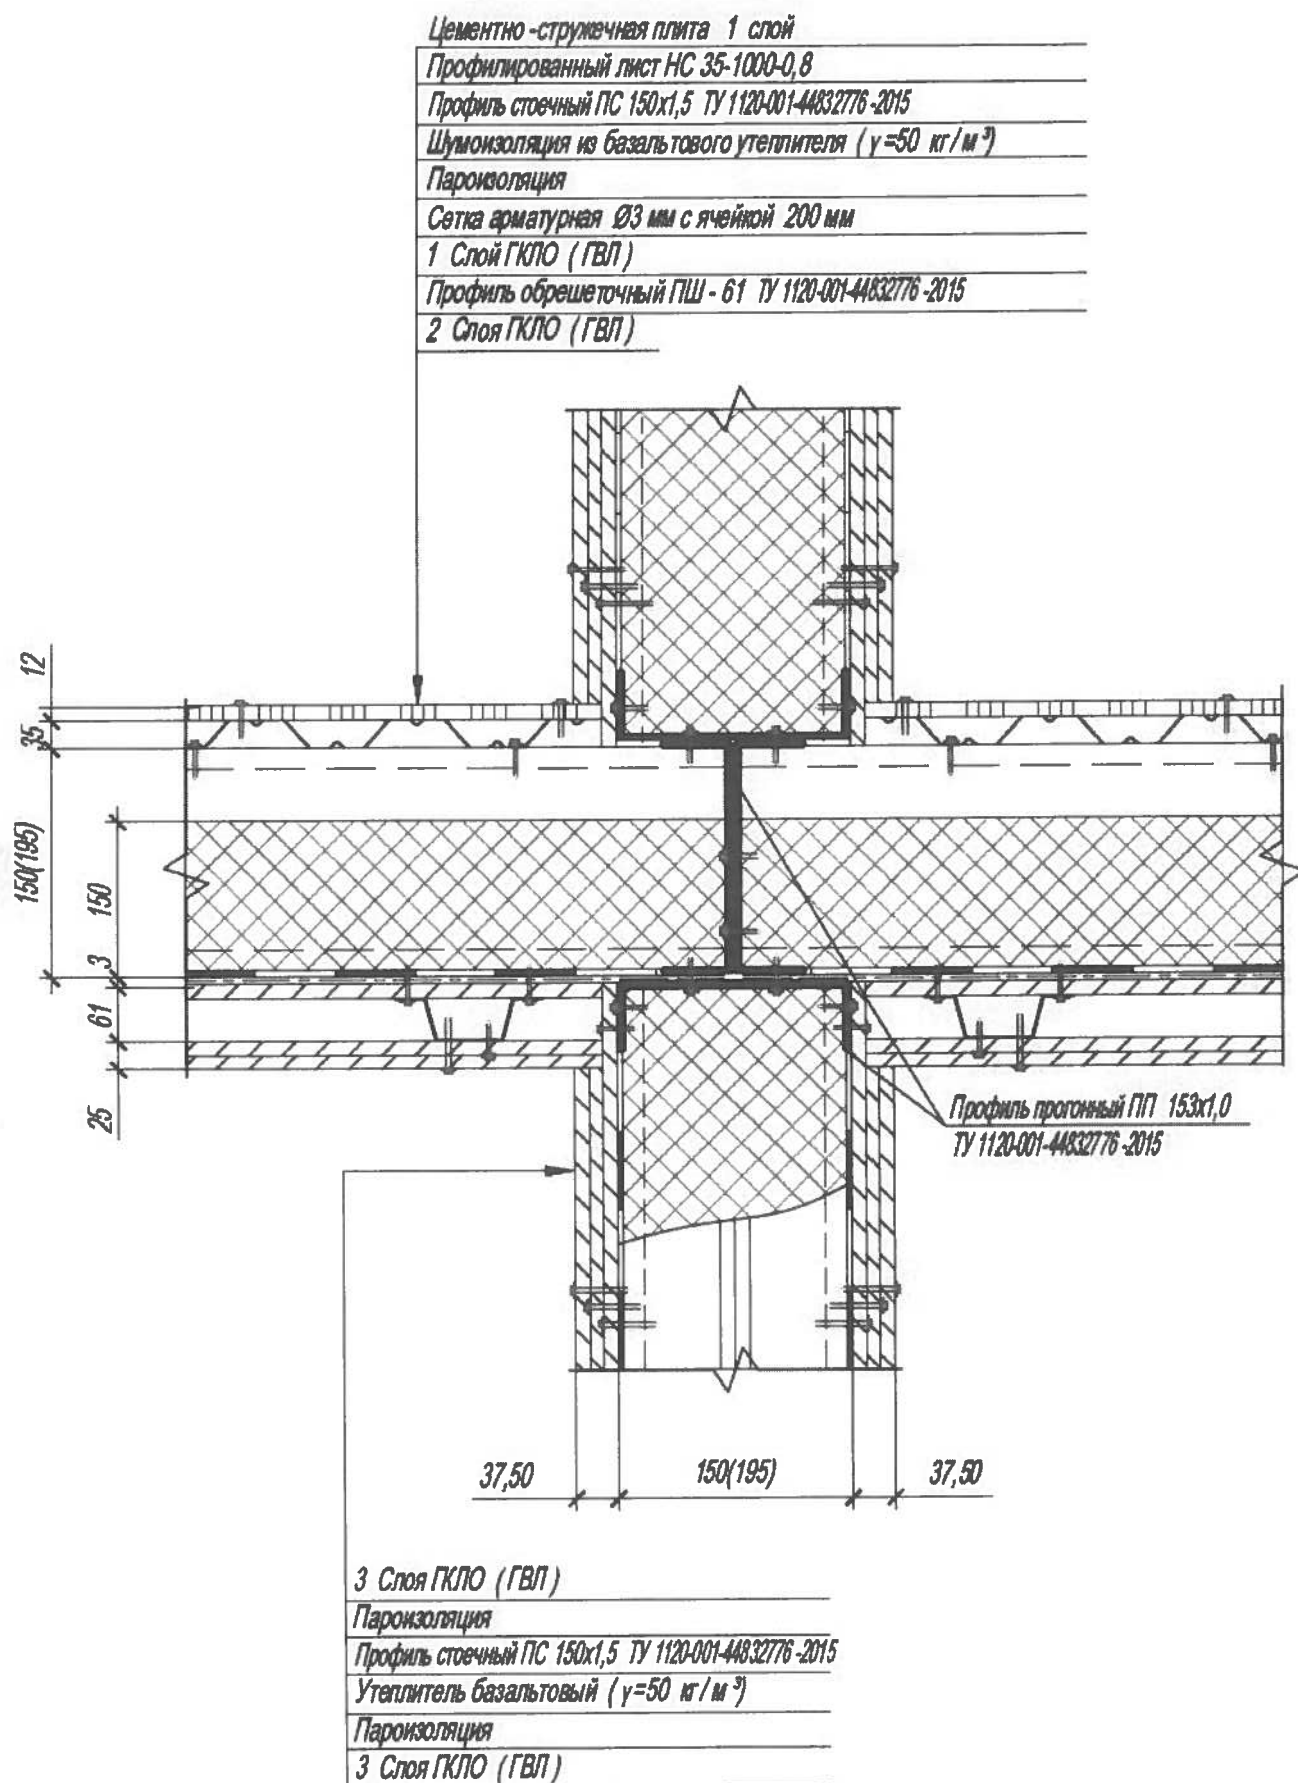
Узел крепления и опирания конструкций междуэтажных перекрытий на внутреннюю несущую стену
